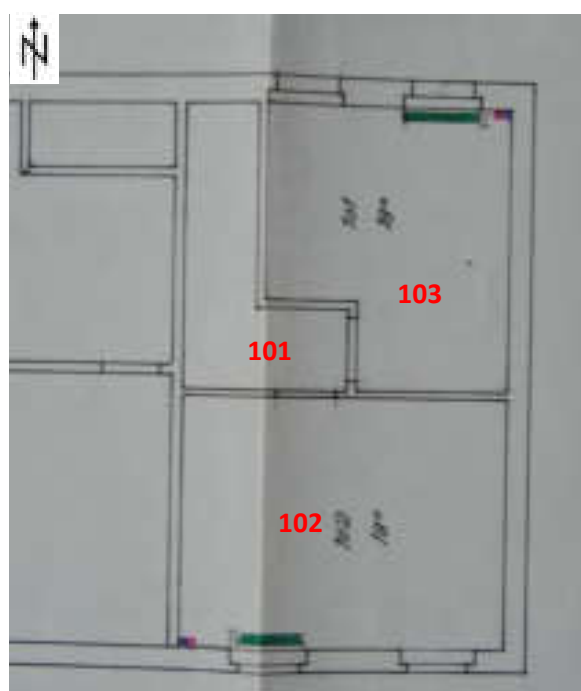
Grundriss OG (östlicher Gebäudeteil). Quelle: GdeA.
